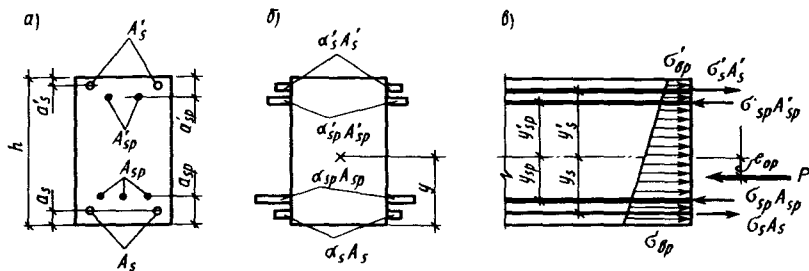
К определению напряжений в бетоне при обжатии: а — схема расположения продольной арматуры; б — приведенное сечение; в — схема усилий в сечении предварительно напряженного элемента
